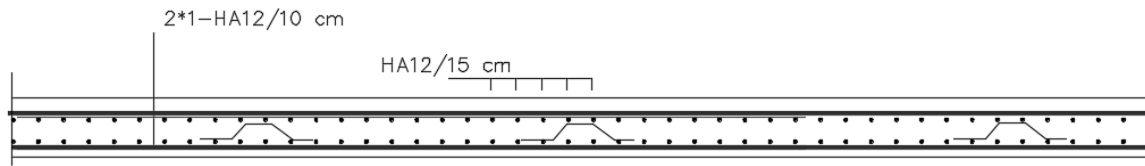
Coupe A-A : Ferraillage de la dalle.
